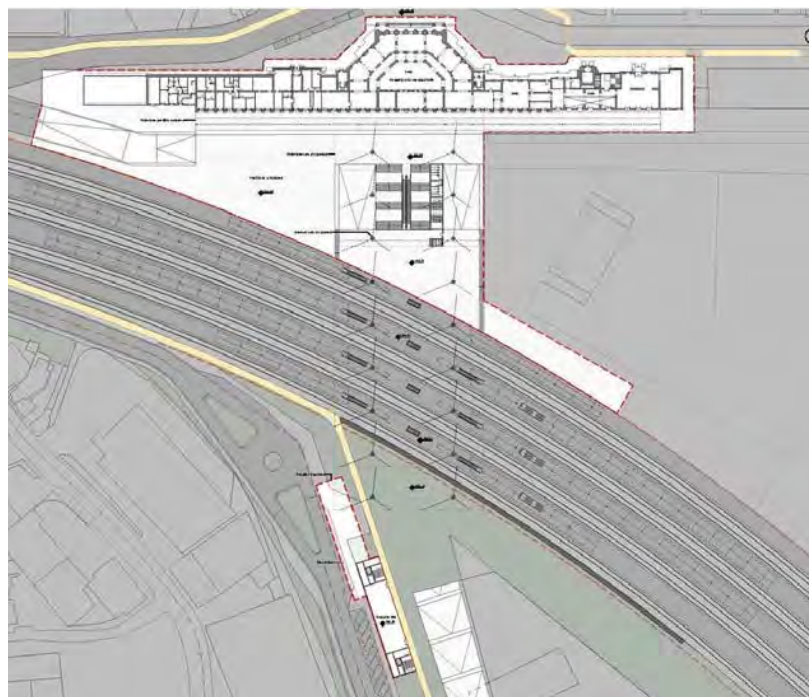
Estratto Tav 3.3.2 – pianta del nuovo piazzale di stazione
